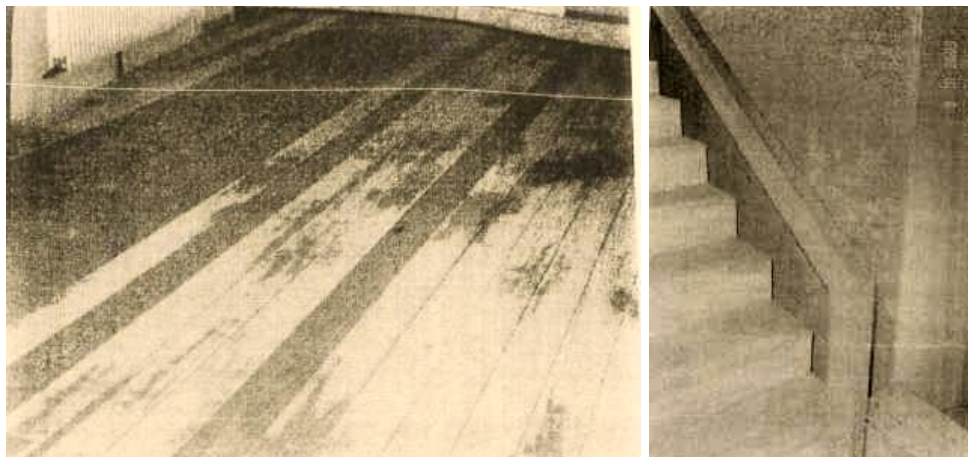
Estado de la tarima de madera en planta baja. Figura 711. Barandilla de escalera a reforzar. (BARRAGÁN DEL PUERTO, N., 2009).
